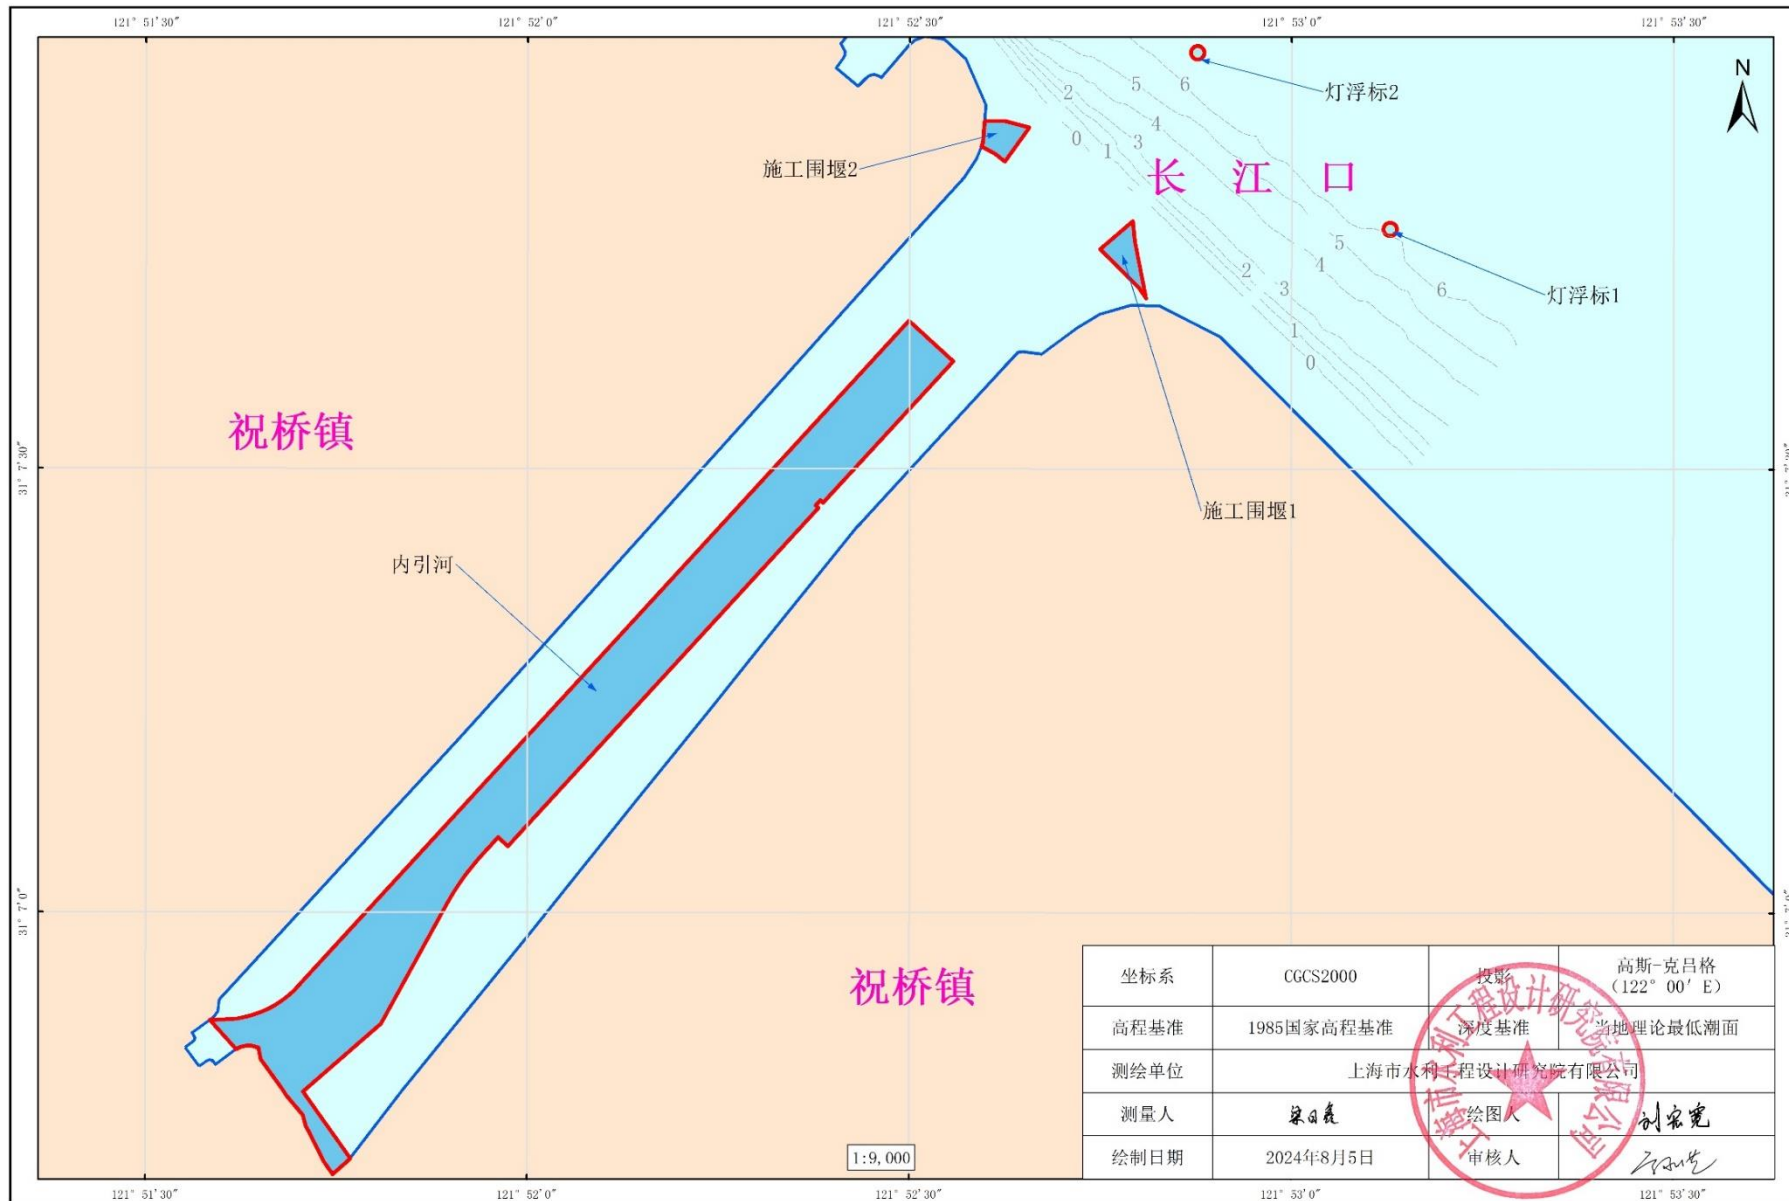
已批复宗海平面布置图（施工配合设施）
